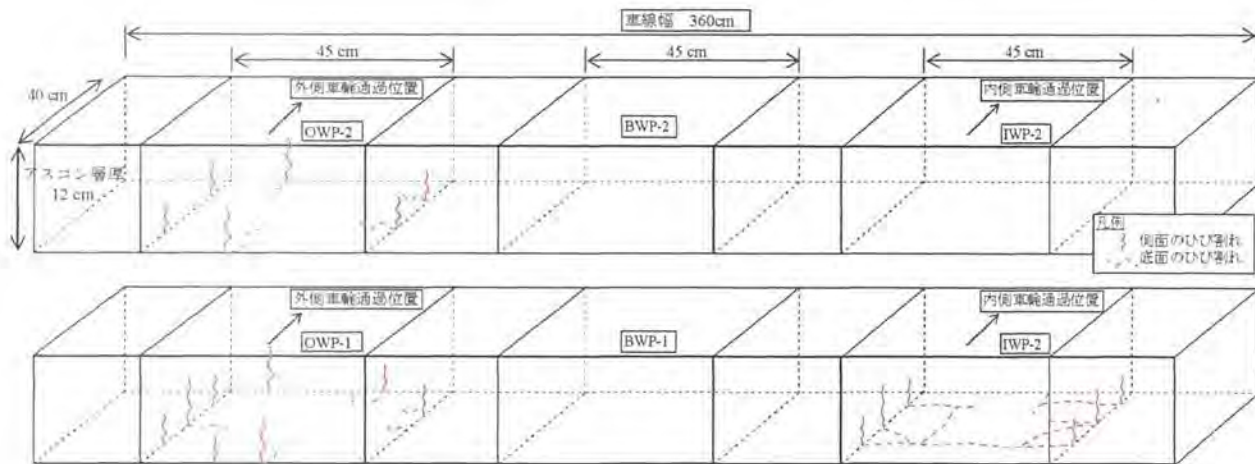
2002年(H14年)開削調査による底面ひび割れ発生状況
